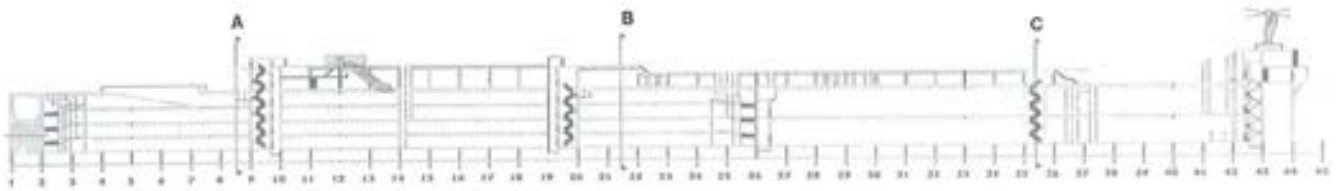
Sección longitudinal del dique con indicación de las secciones principales de instrumentación (A, B, C).
